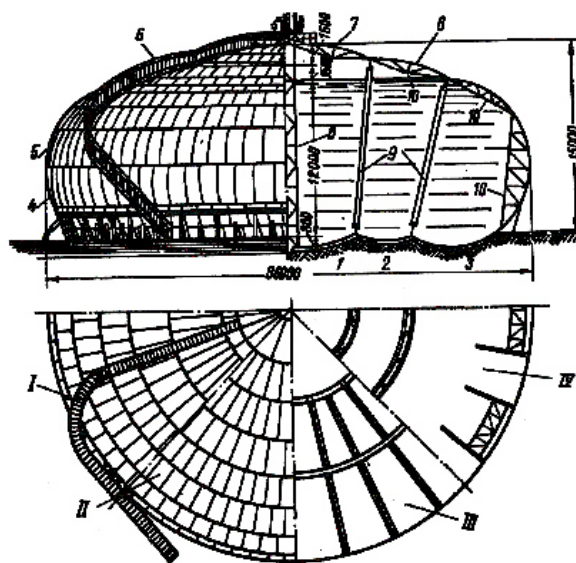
Багатокупольний (багатоторовий) резервуар
